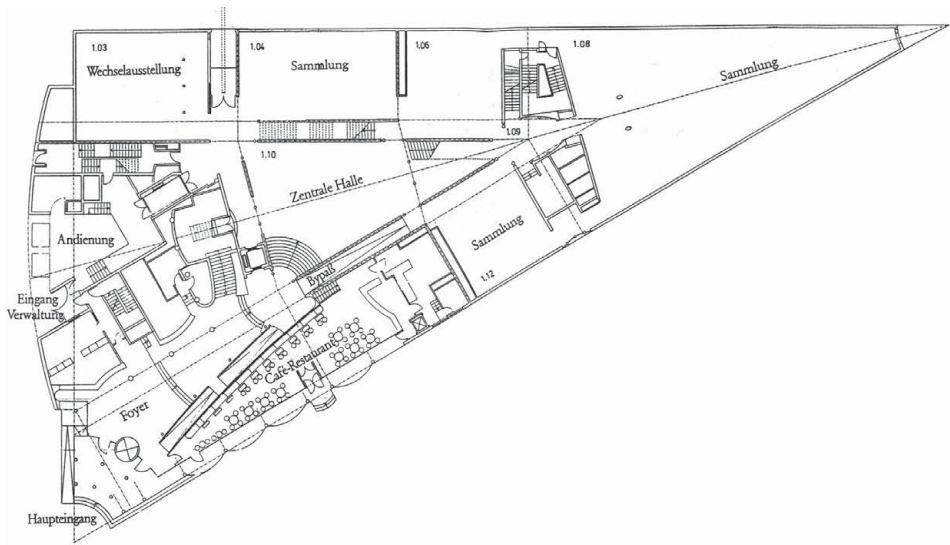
Museum für Moderne Kunst, Grundriss, Erdgeschoss
